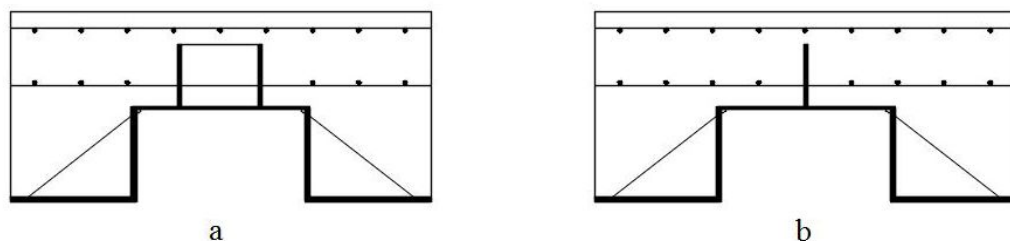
3 – Asigurarea conlucrării între structura de oțel și cea de beton prin conectori [17]
